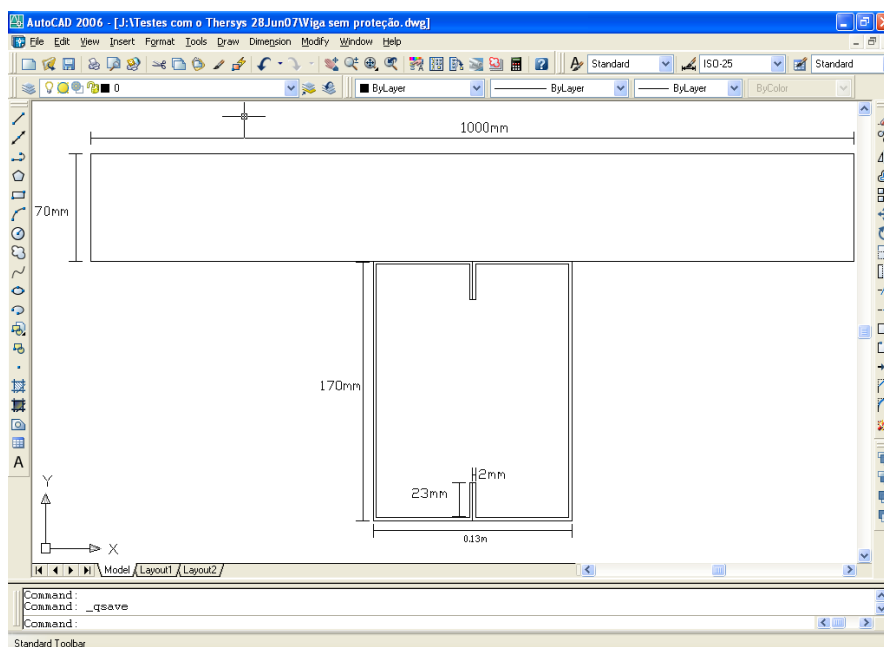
Dimensões da viga mista de aço e concreto analisada
